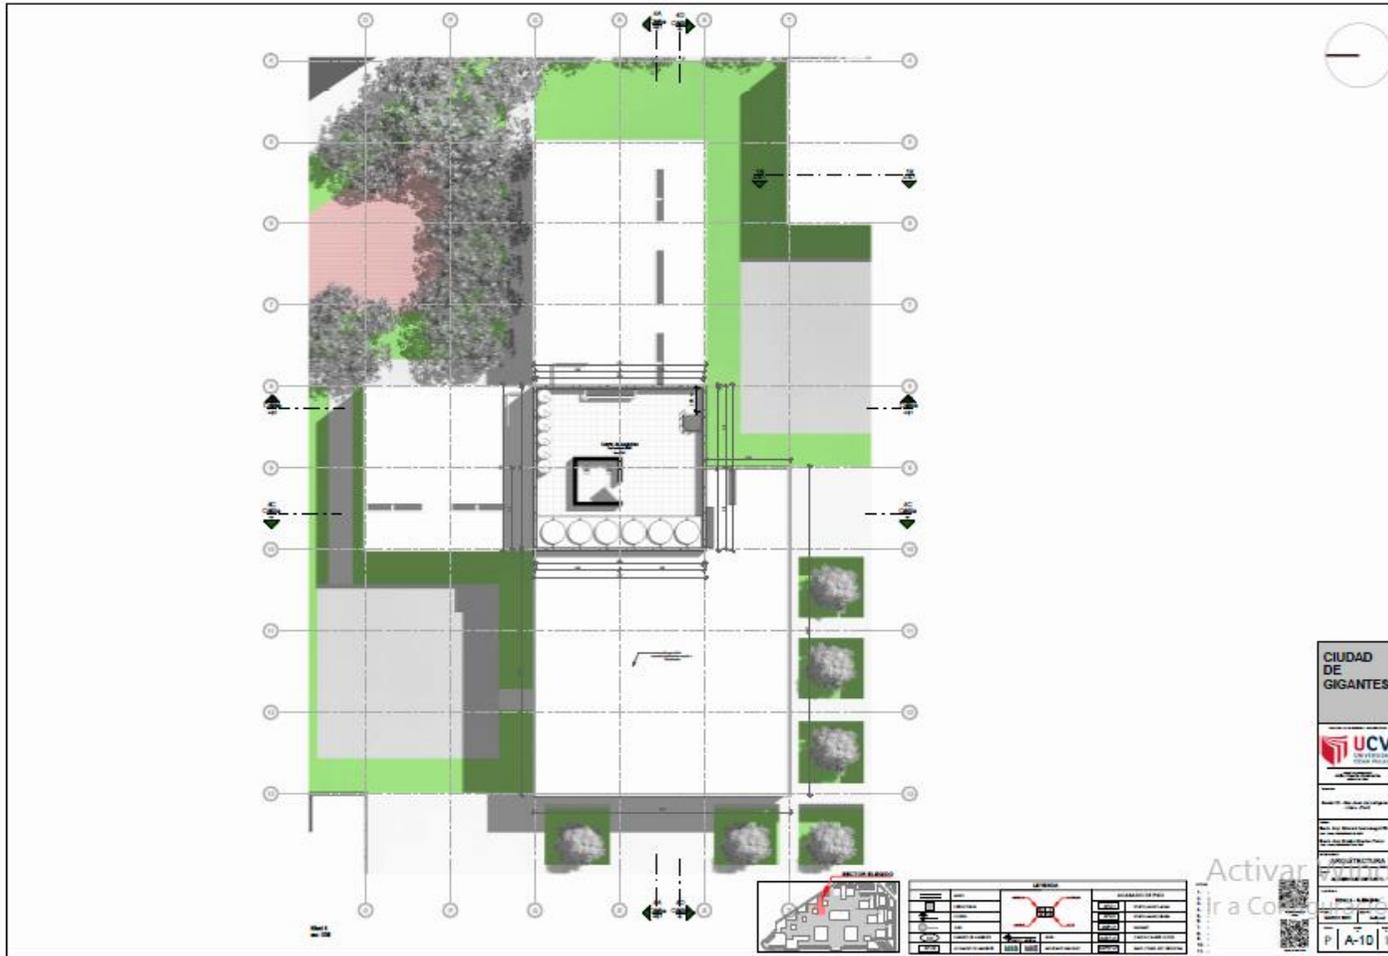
Plano de Planta Sector Residencia (Sector Elegido) Azotea
